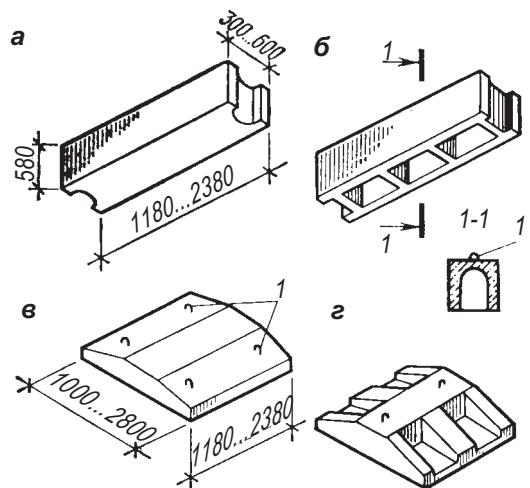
Елементи збірних бетонних і залізобетонних фундаментів:
